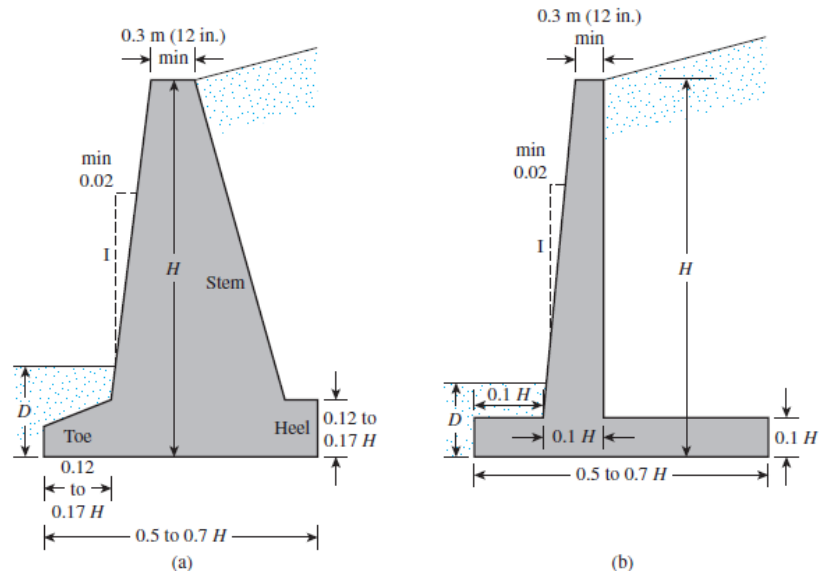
Predimensionamiento Braja muro de gravedad y muro en voladizo
